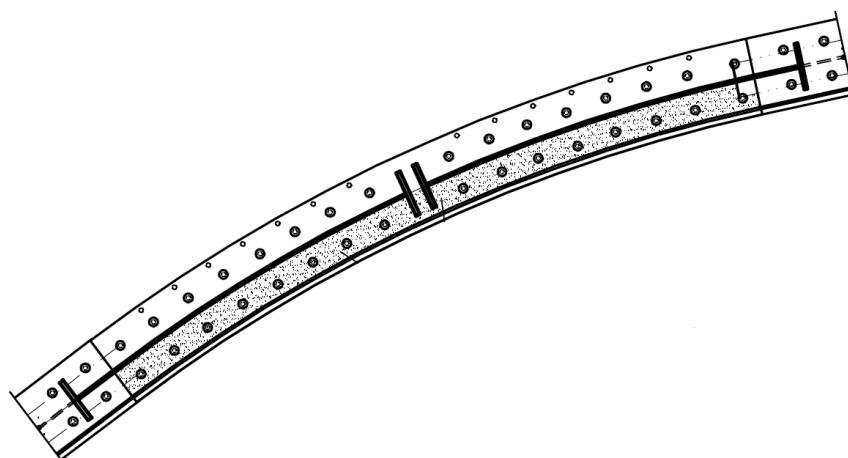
Chapas de aço integradas nas guardas, na zona dos pilares [25].
